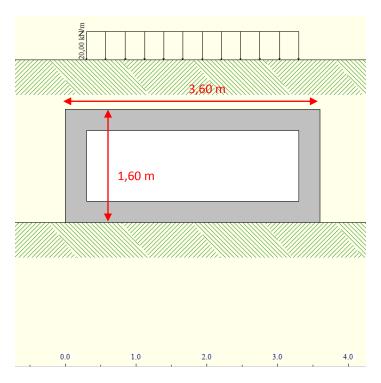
Schematizzazione della sezione di calcolo Pozzetto sbocco
